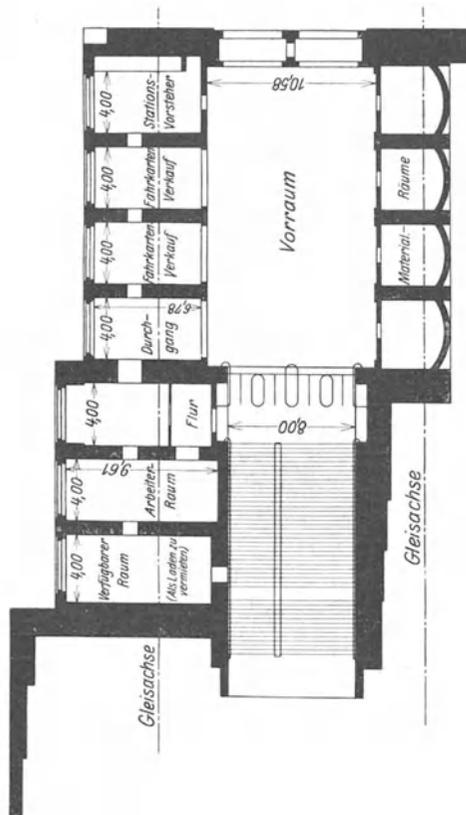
Haltestelle Flurstraße der Hamburger Hochbahn.
